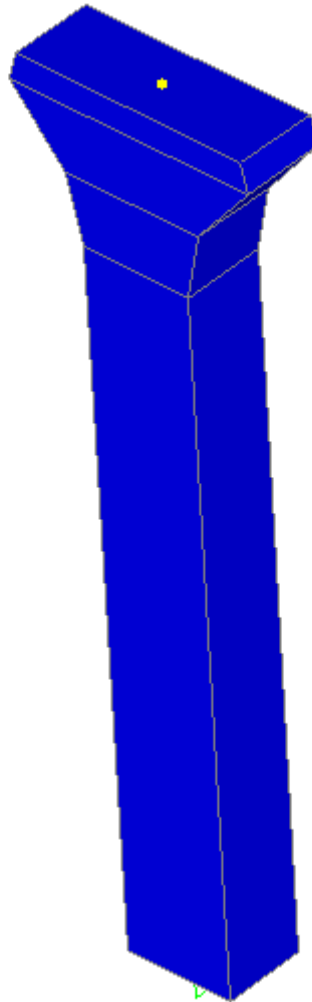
Vista 3D di una delle pile del viadotto.
